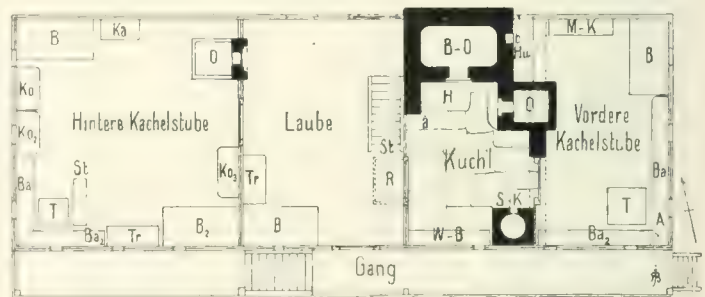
Grundriß des Alpenbauer-Hauses. 1:200.
